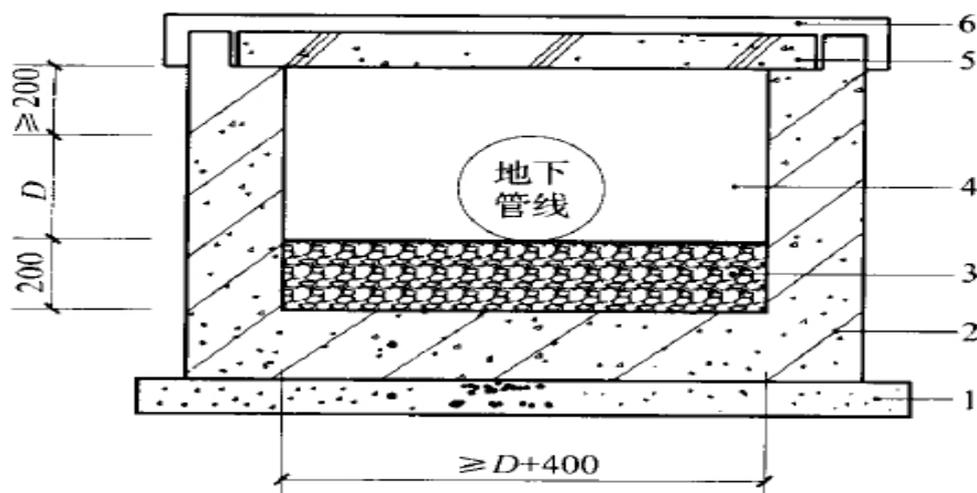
抗渗钢筋混凝土管沟防渗层示意
